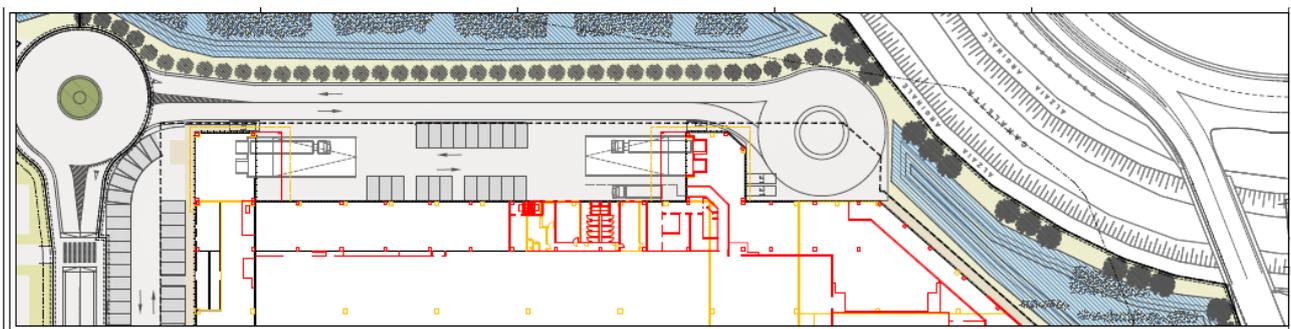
Tavola comparativa - pianta primo piano (FONTE: elaborati Ing. Endrizzi)
